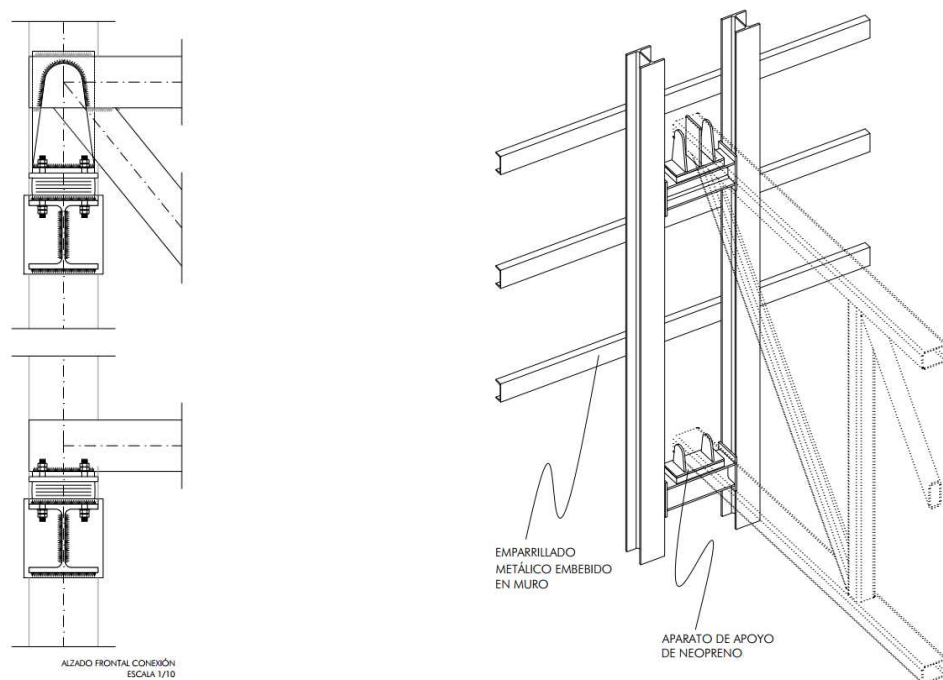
Detalle de la conexión de la cercha en los muros mediante aparato de apoyo de neopreno
